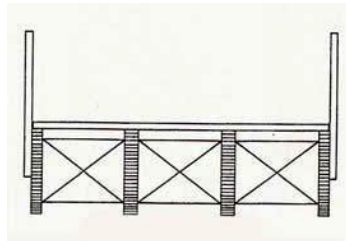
Viga inferior com contraventamentos (Moderne Holzbruecken, 2003)
